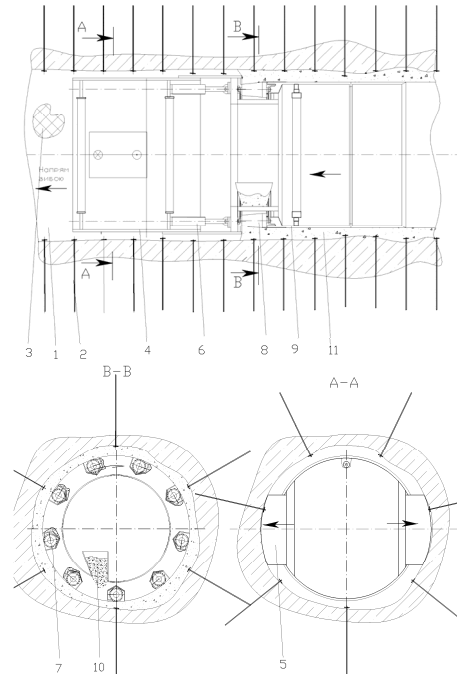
Схема прогресивного способу анкер-бетонного кріплення капітальних виробок шахт і тунелю: 1 – виробка; 2 – анкерне кріплення; 3 – металева стінка; 4 – пересувна секція; 5 – поперечні домкрати; 6 – поздовжні домкрати; 7 – роторне кільце; 8 – формуючі роликми; 9 – опалубна секція; 10 – живильник; 11 – бетонний шар
